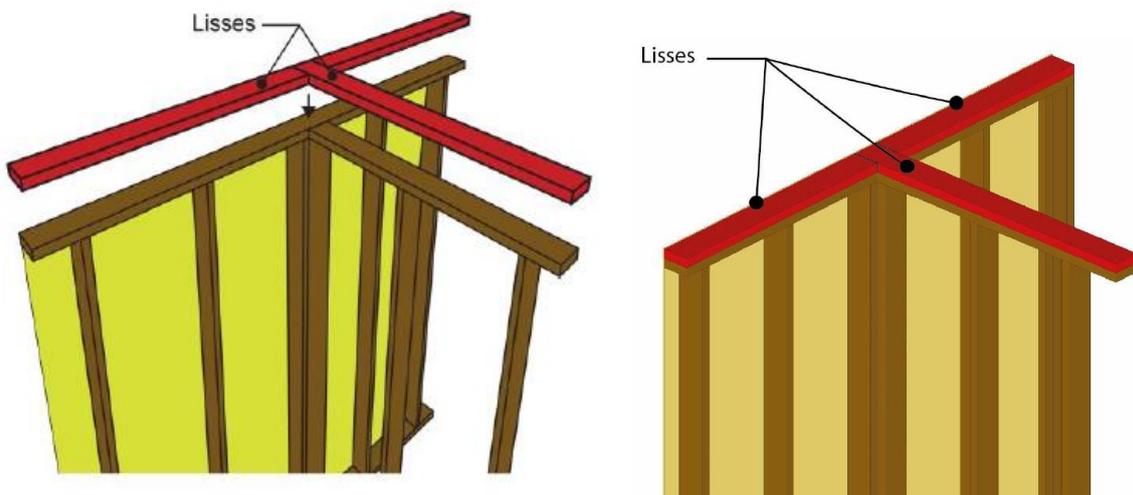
Exemple de mise en œuvre de la lisse haute sur un assemblage mur intérieur / mur extérieur
